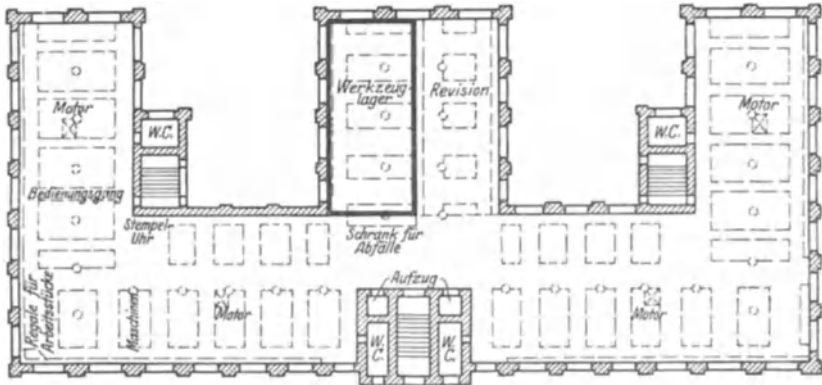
Grundriß eines Stockwerkes einer Fabrik mit Werkzeuglager.
